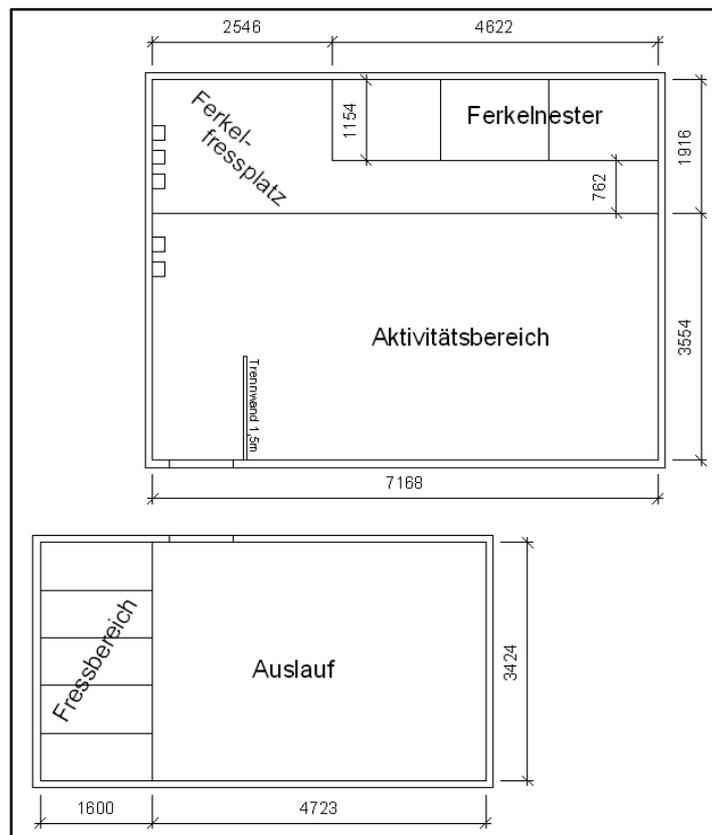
Grundriss für das Haltungssystem Gruppensäugen
